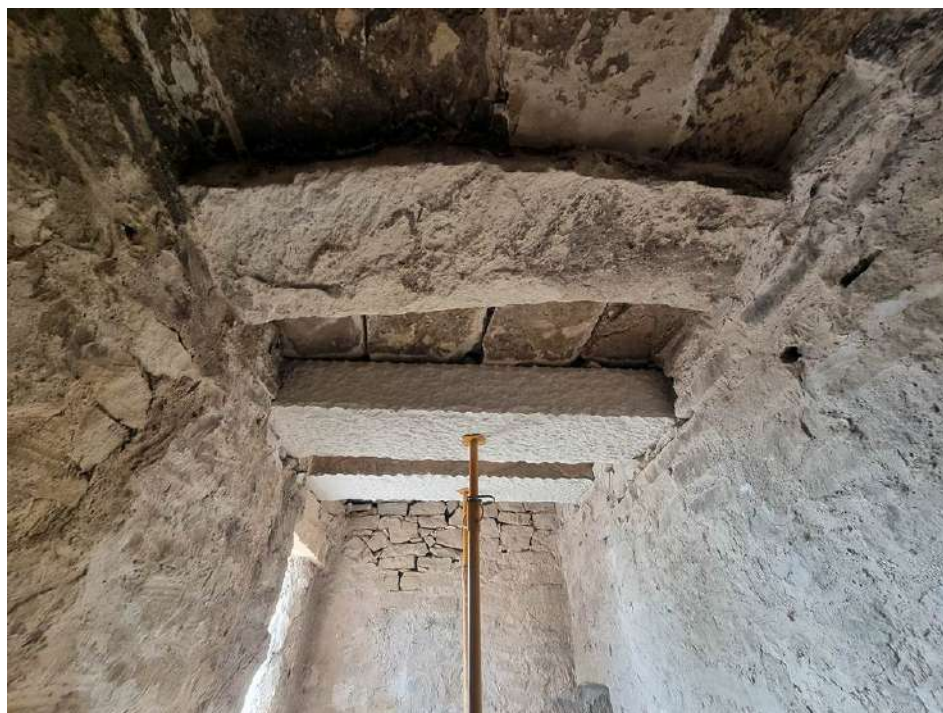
Interior del refugio con las vigas nuevas colocadas y sus losas superiores
